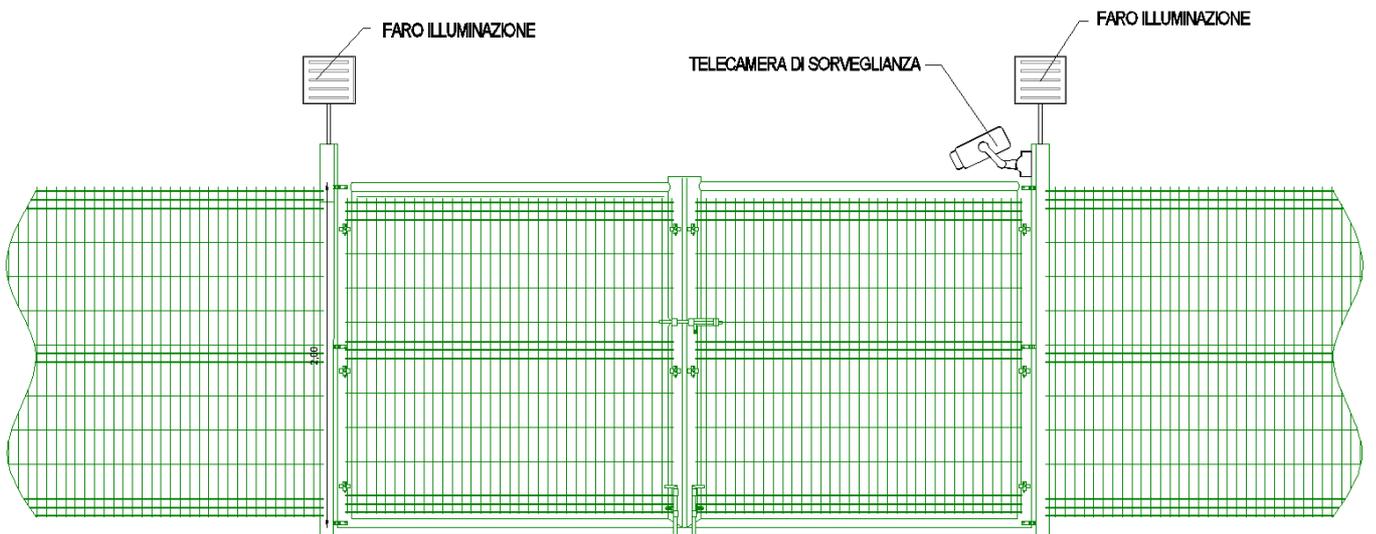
Prospetto accessi con illuminazione e videosorveglianza
